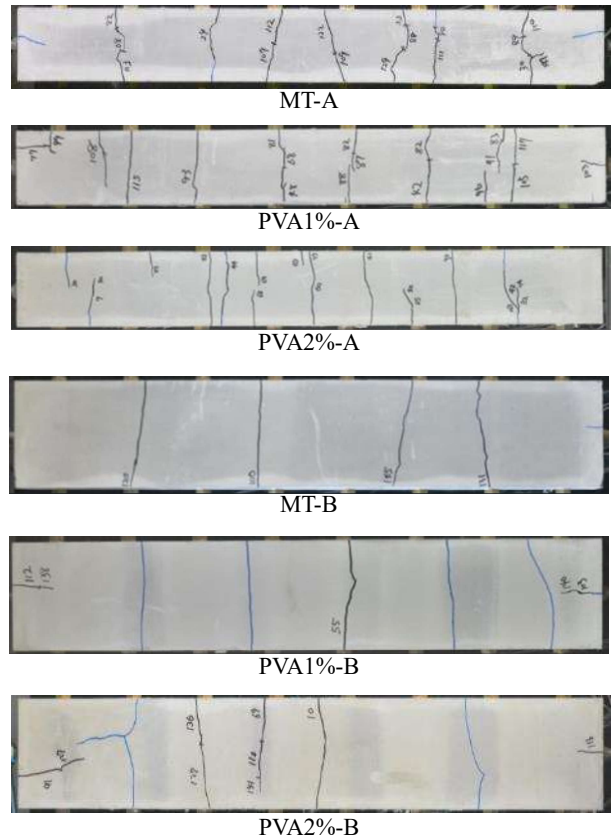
ひび割れ状況（鉄筋降伏時）
